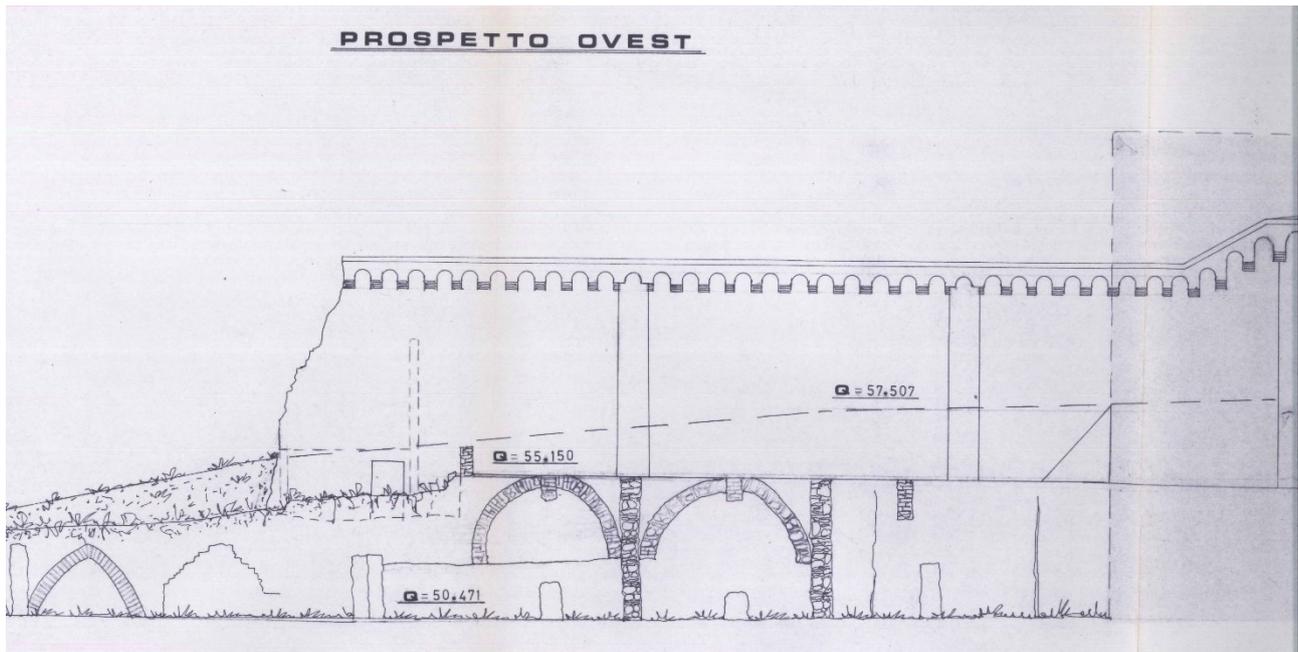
Prospetto ovest muro di ronda interessato dall'intervento di consolidamento
